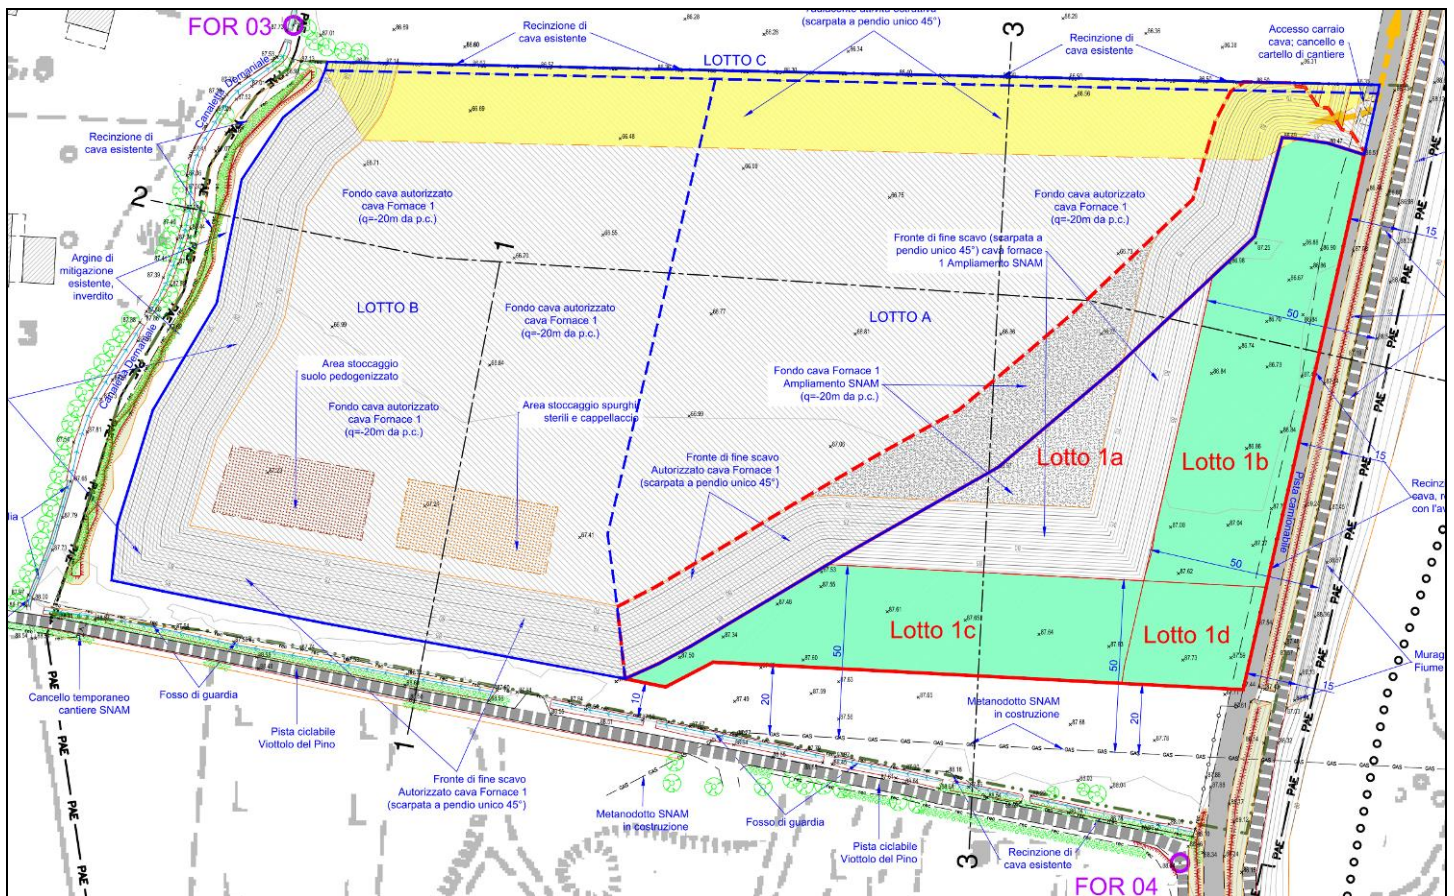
Stralcio della Tav. 06 “Progetto - Planimetria di minimo scavo”.
